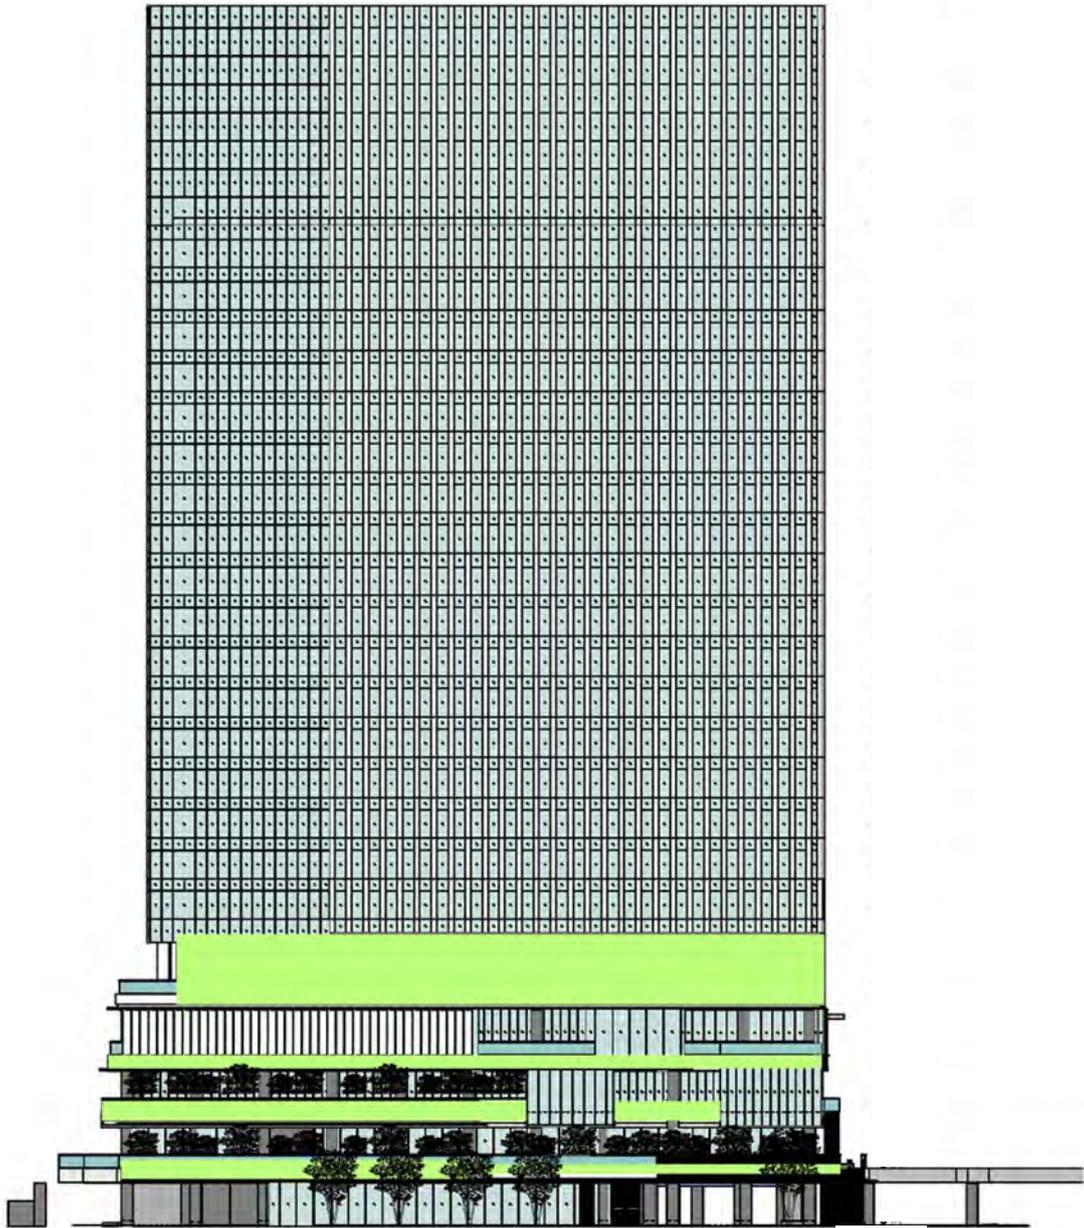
(2) 立面图 (北立面图 S=1:800) 【变更前】
